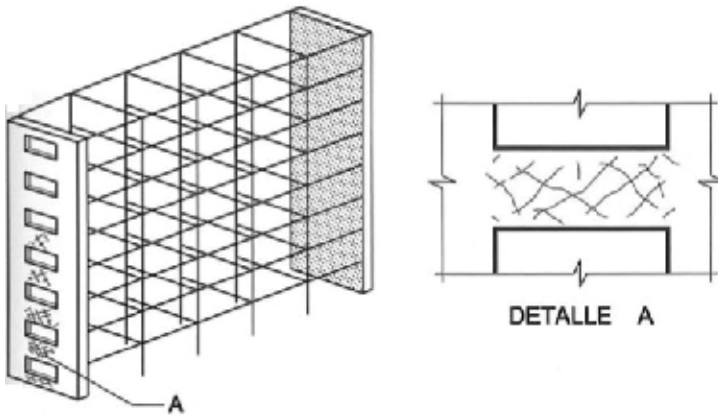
Fisuración en pantallas de corte con aberturas (Fuente: Calavera, 2005)
